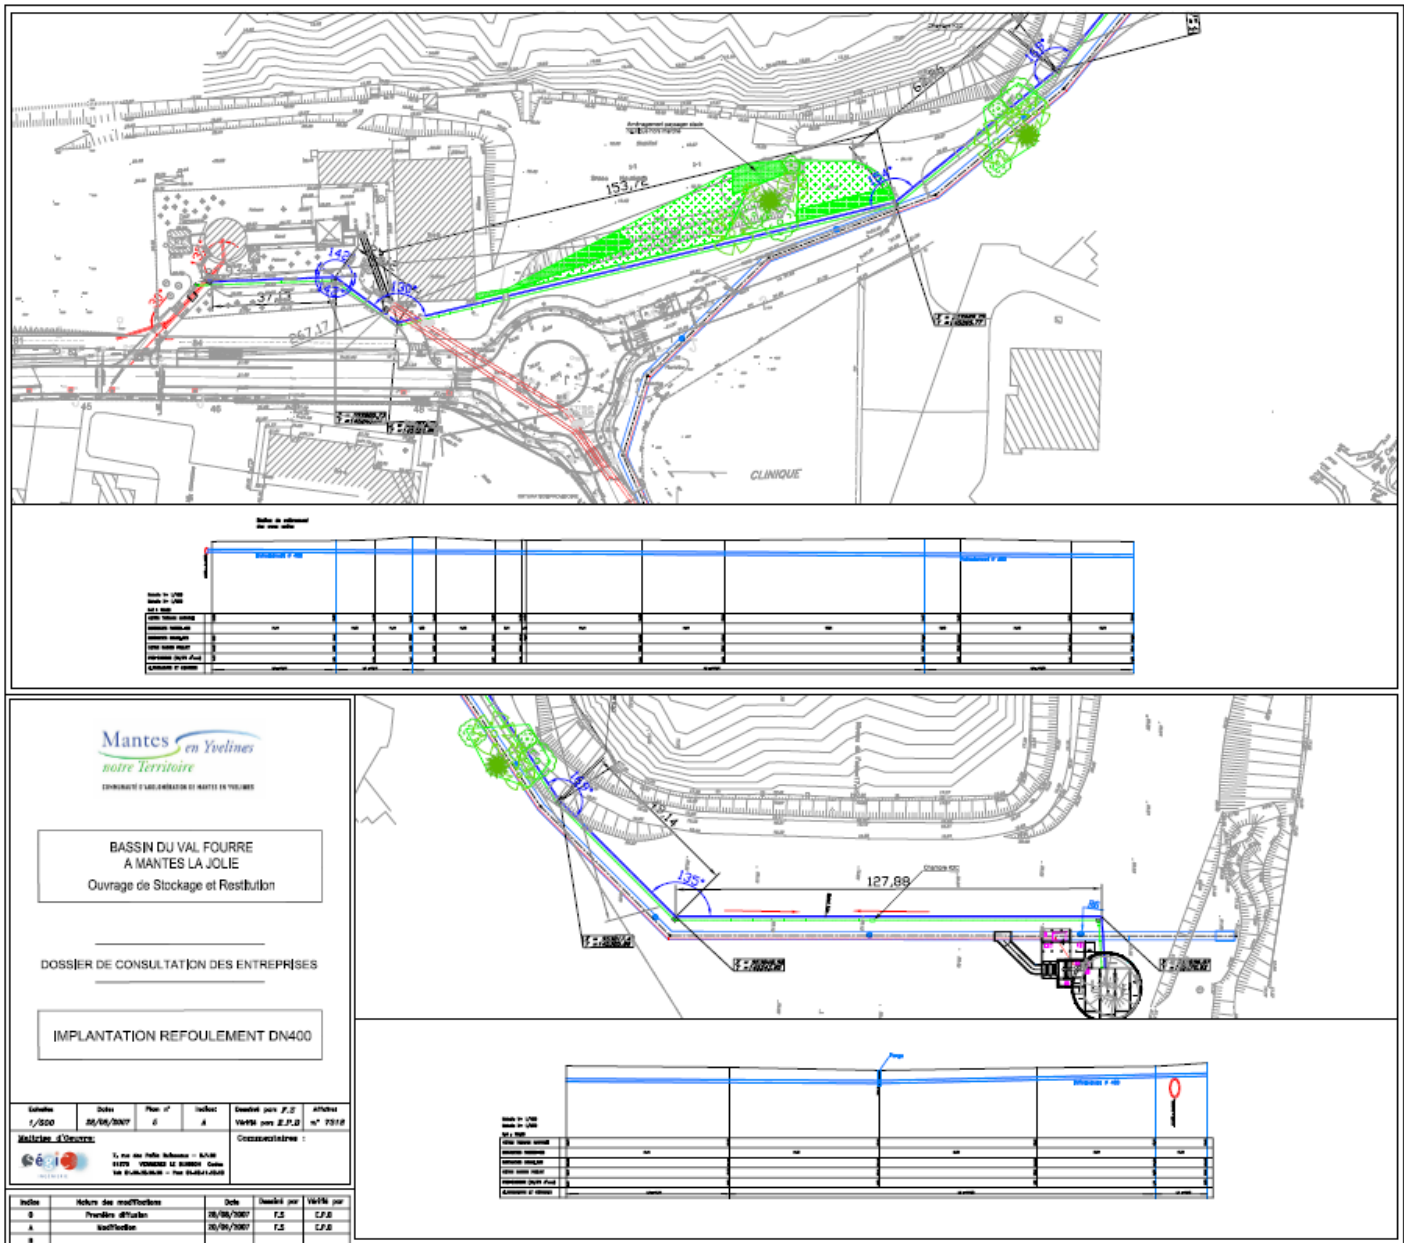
Vue en plan et profil en long du réseau de refoulement DN400
